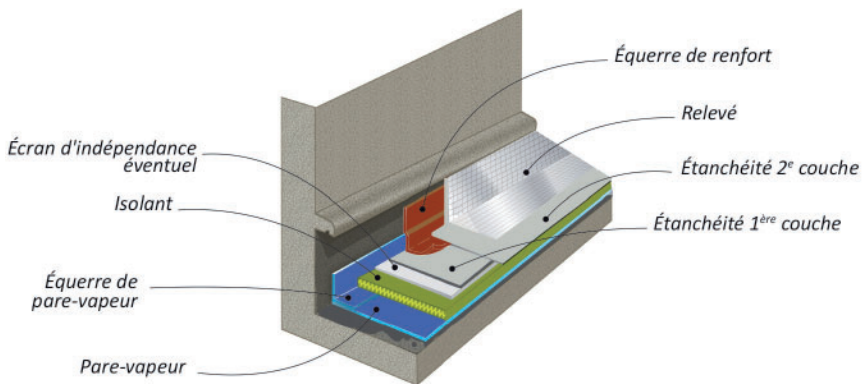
Éléments constitutifs d'une étanchéité de toiture-terrasse
